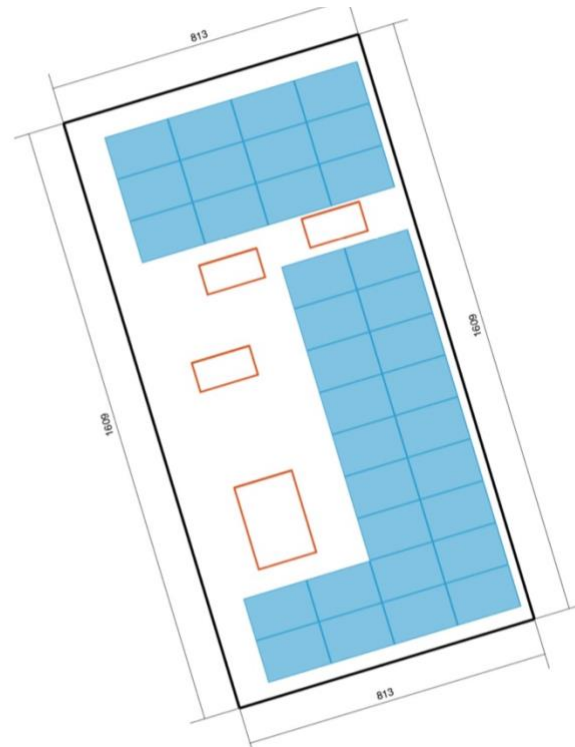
Rickenstrasse 50, Belegungsplan, Dachfläche 1: West
